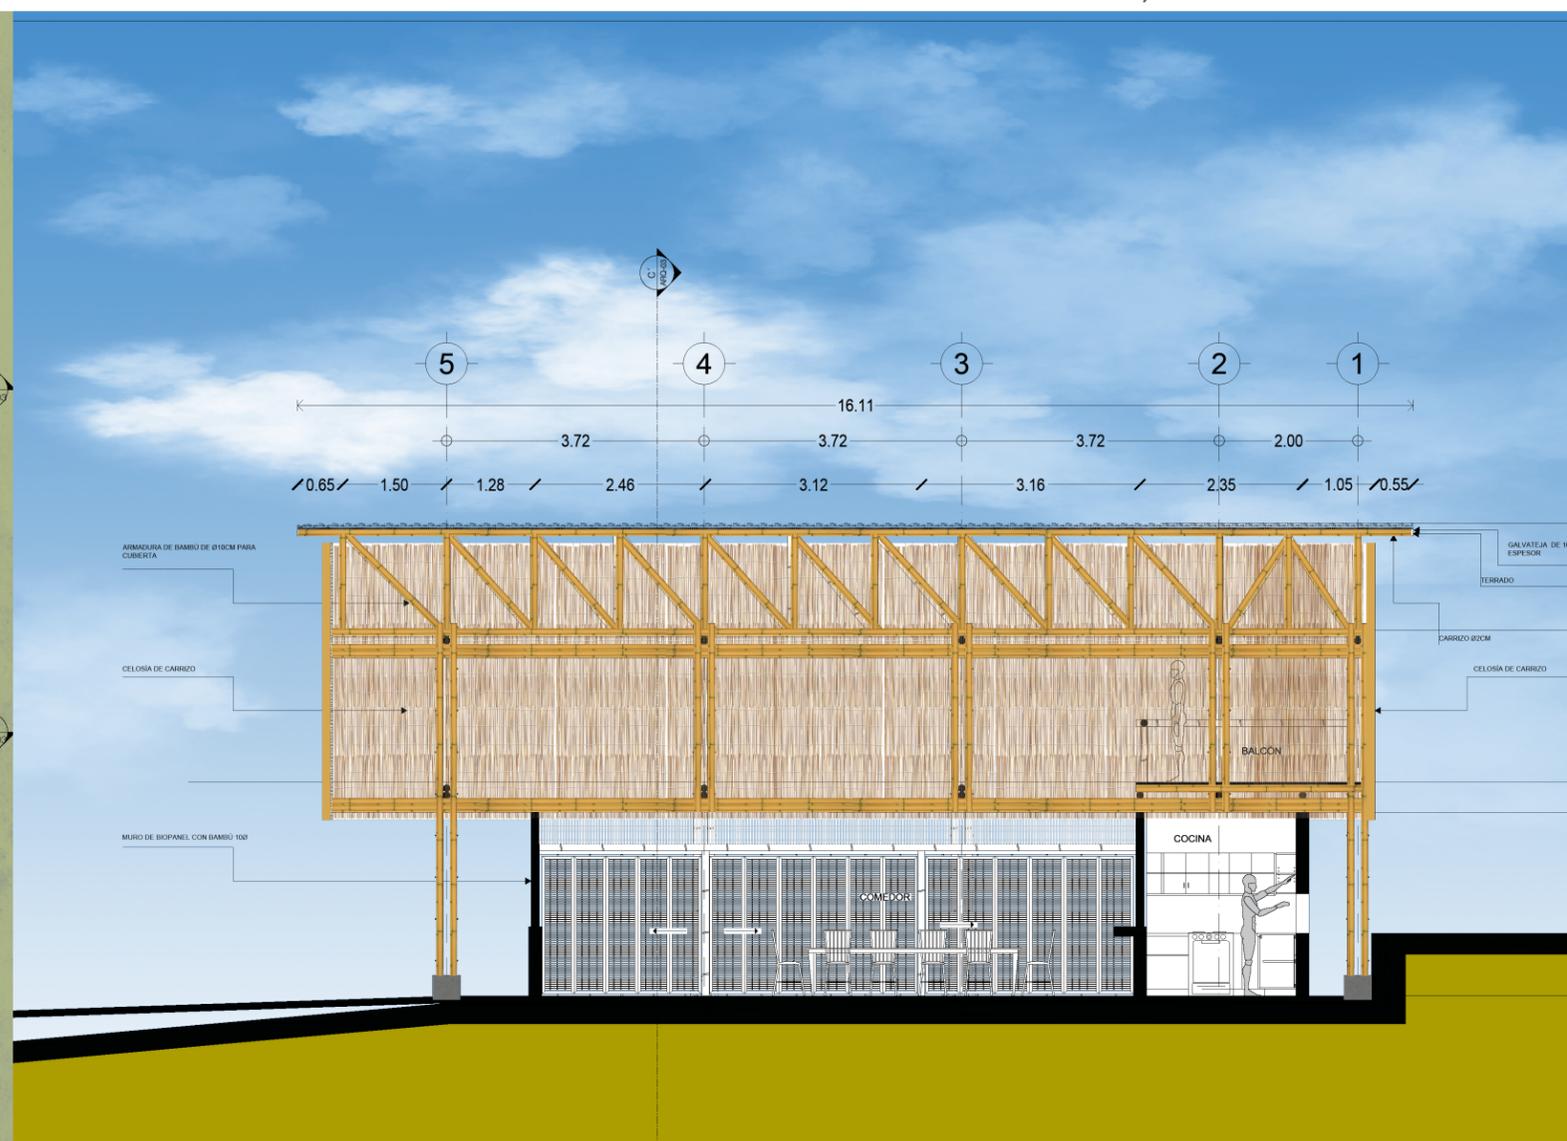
PLANO AMBIENTADO DEL PROYECTO DEL CASCO PRINCIPAL. ESTRUCTURA GENERAL, CORTE DIRECCIÓN SUR.
